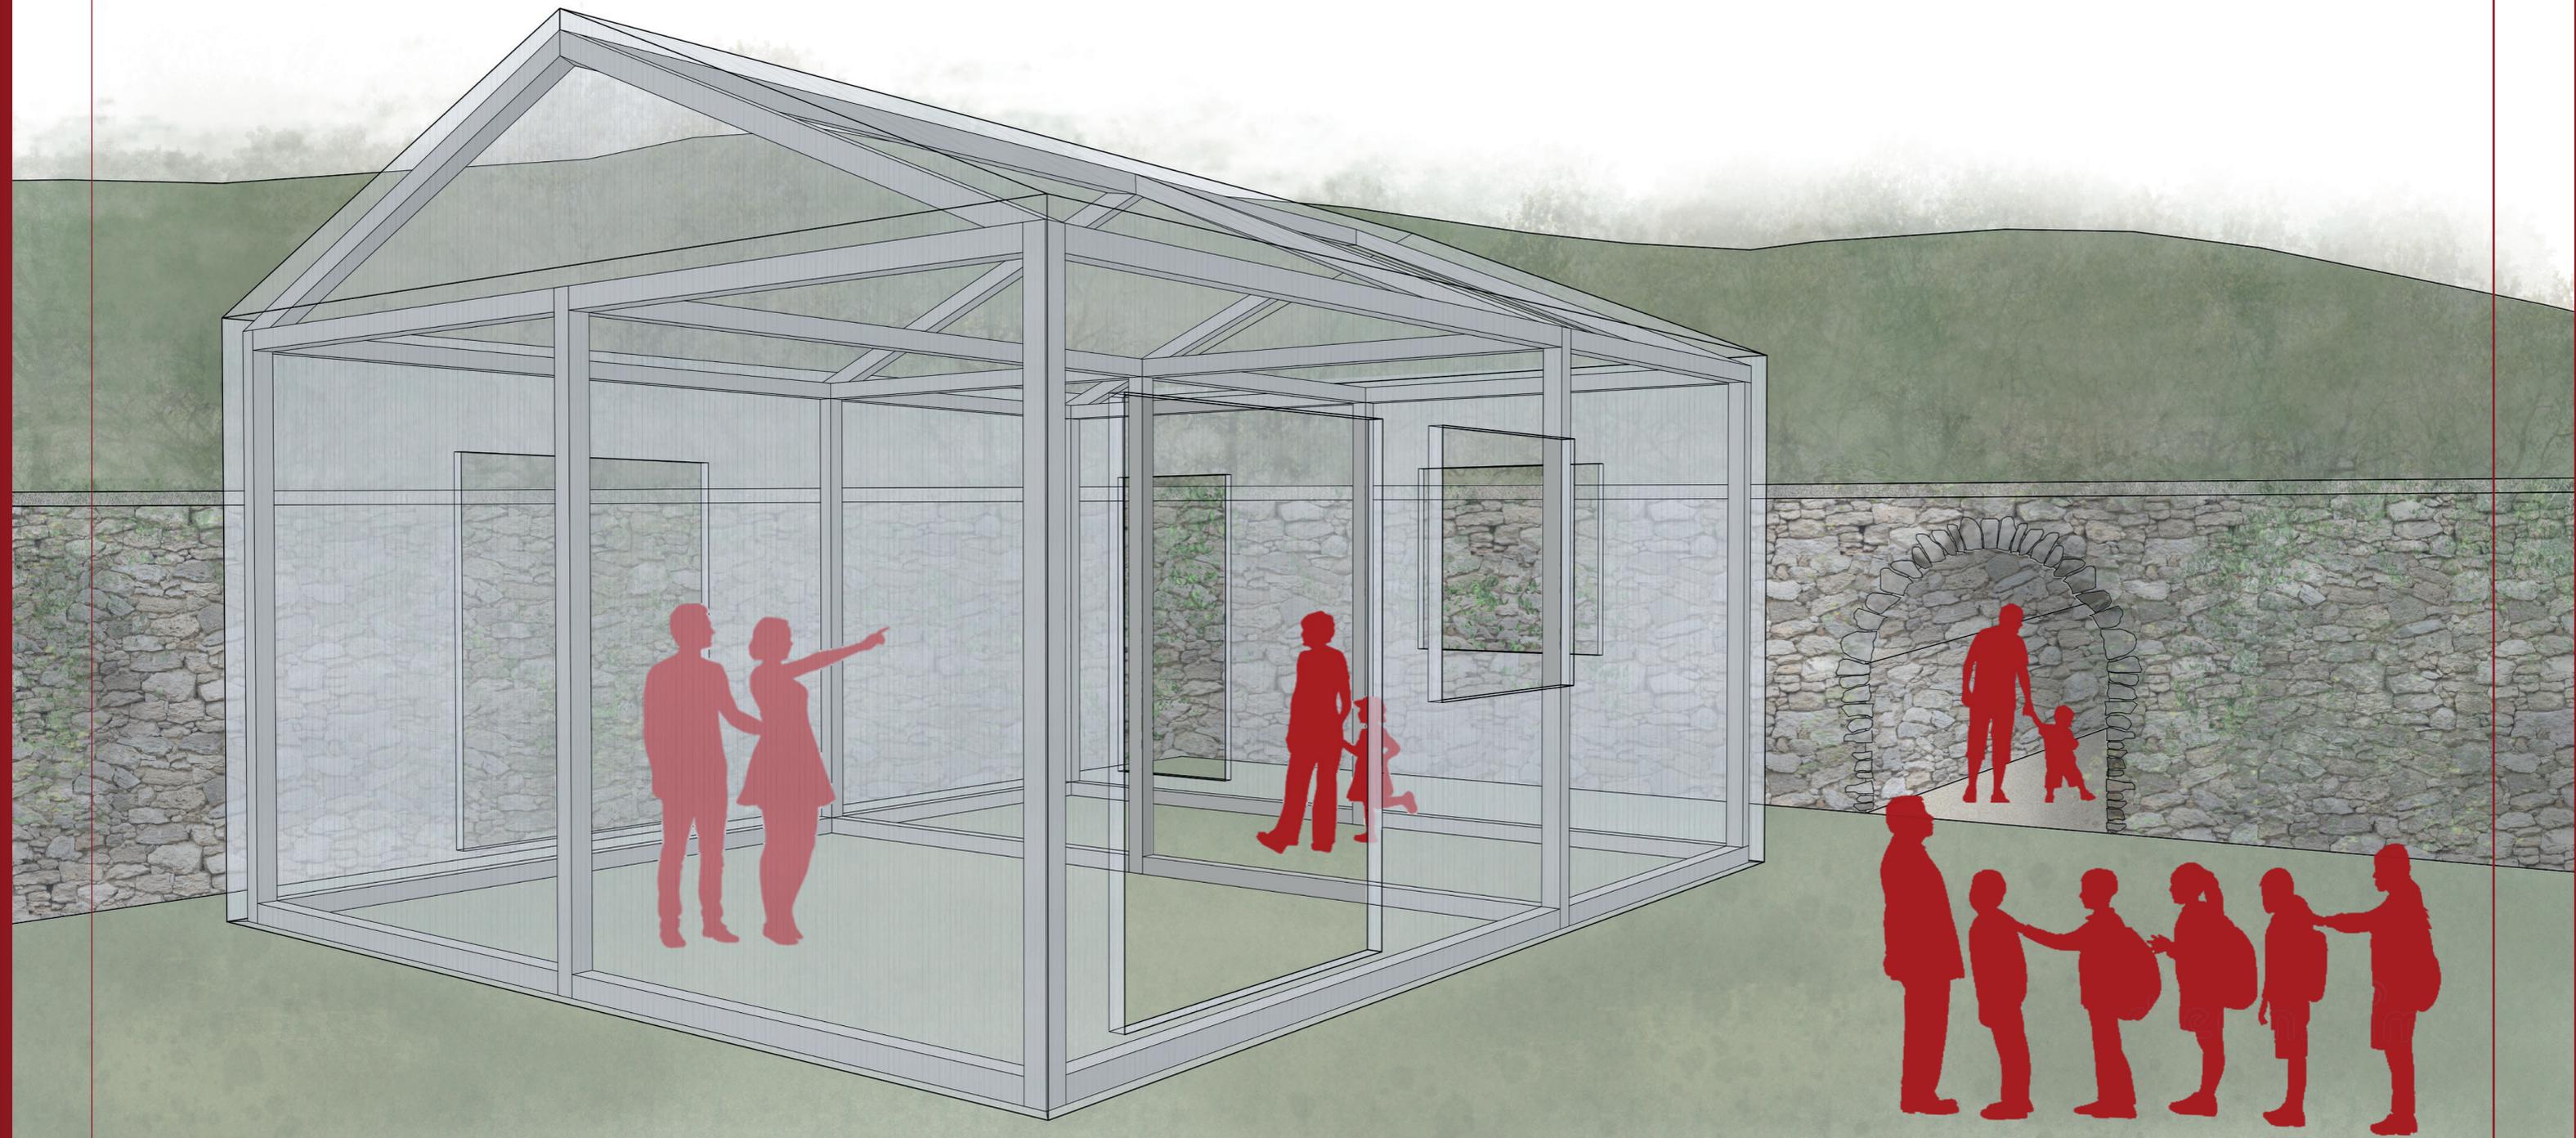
Sezione prospettica delle "casematte", fuori scala, elaborazione delle autrici
